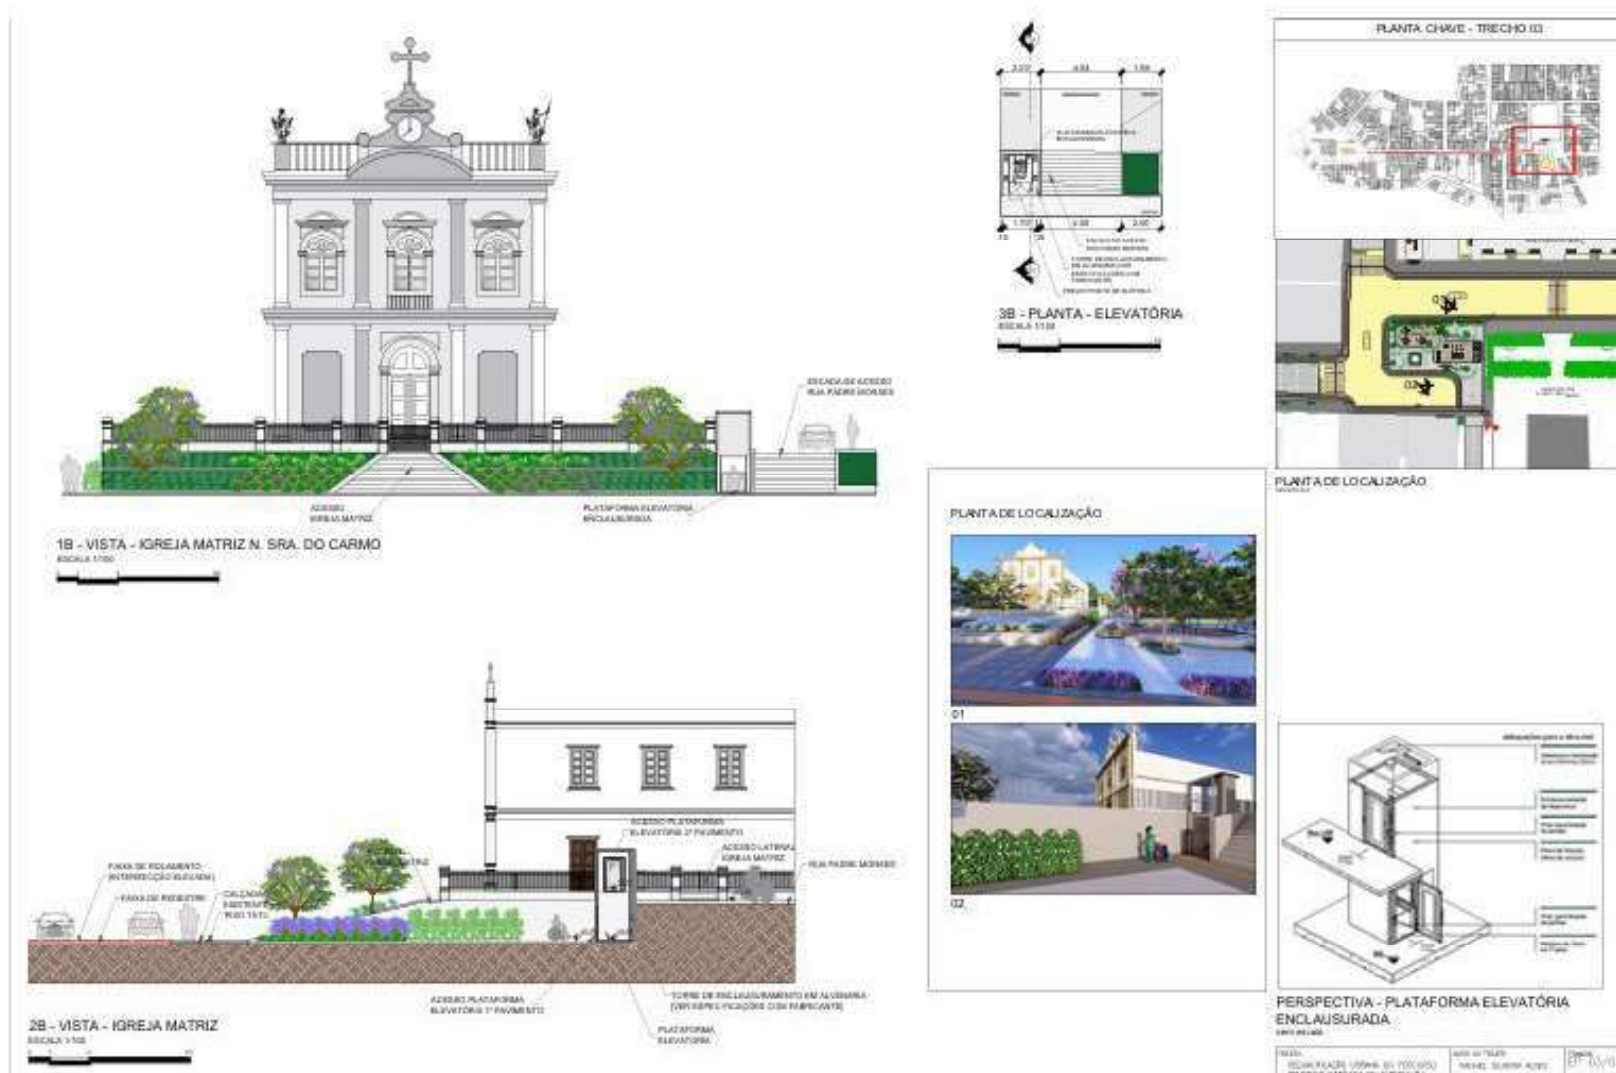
Prancha com Vistas/Planta de Localização/Perspectiva – Detalhe: Elevatória Vertical. Elaboração da autora: junho 2025.
